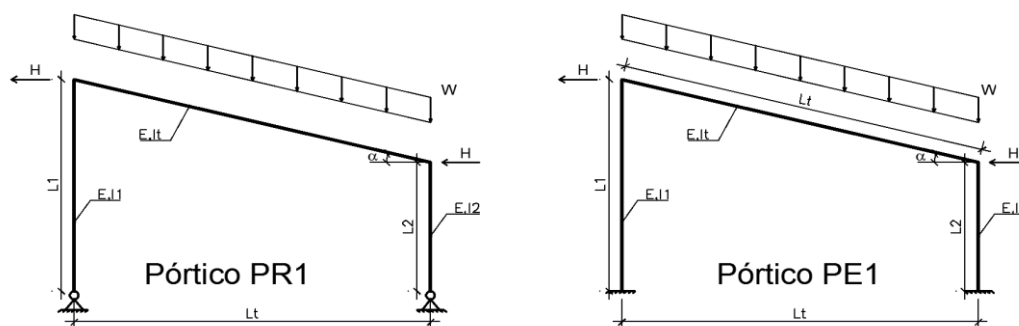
Configuração geométrica e carregamento do pórtico de travessas inclinadas – Pórticos PR1 e PE1
